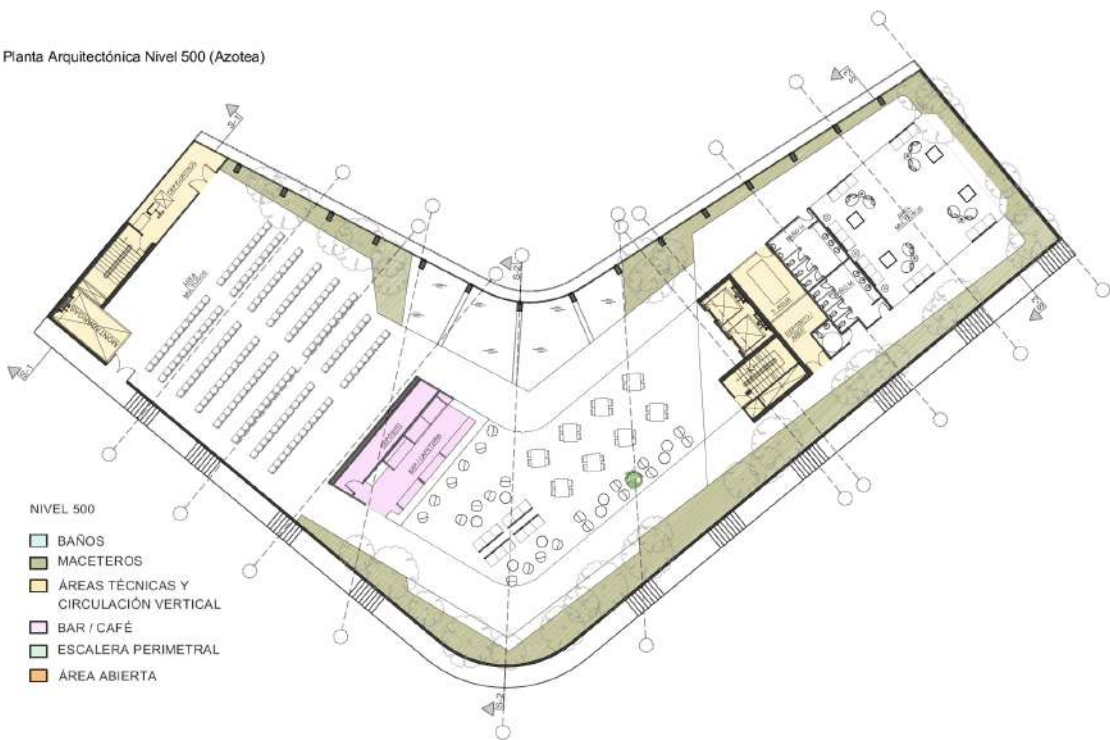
Planta Arquitectónica Nivel 500 / Escala 1:250
